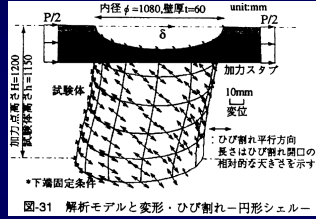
解析モデルと変形、ひび割れ—円形シェル—
